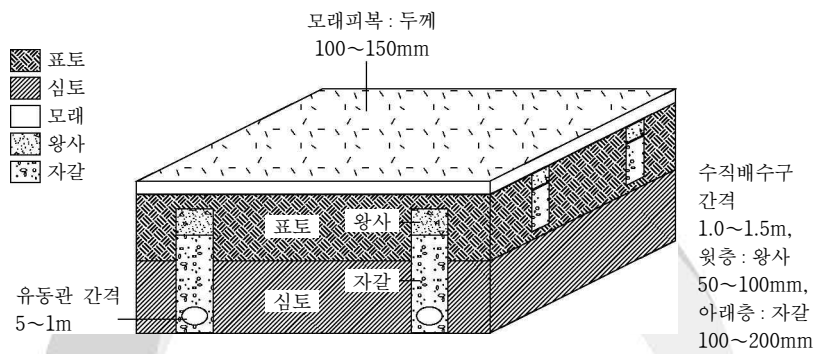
모래카펫지반(sand carpet drainage system)
